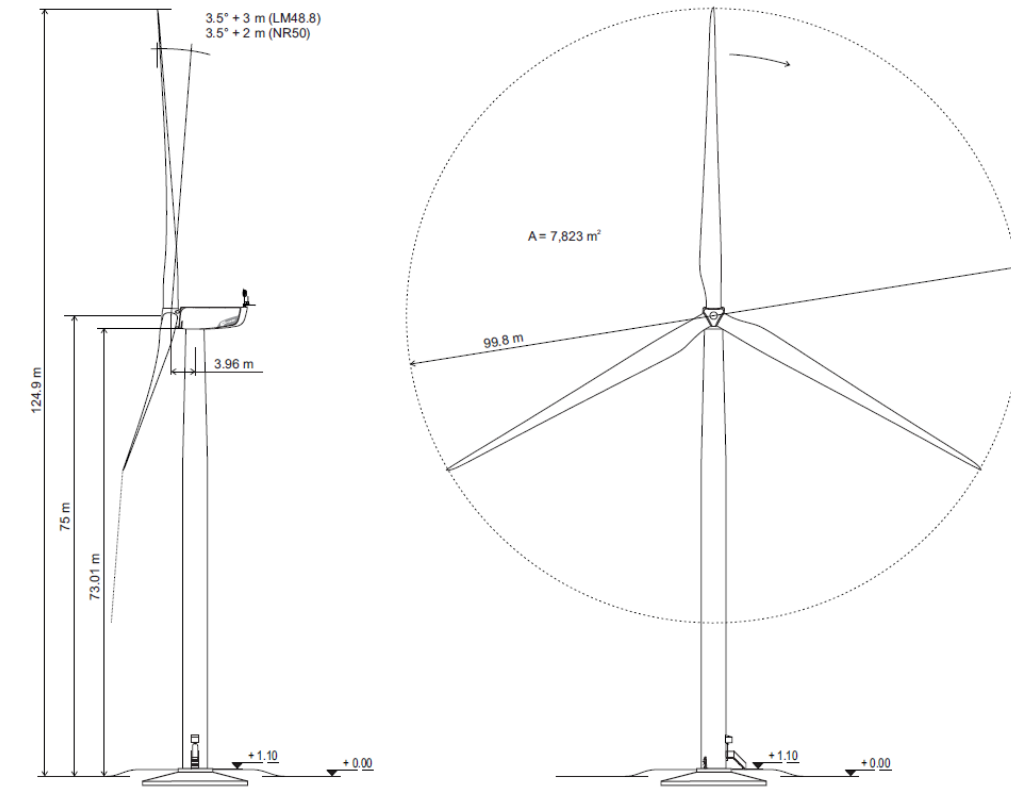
Vue en plan de la Nordex N100-2.5 MW
